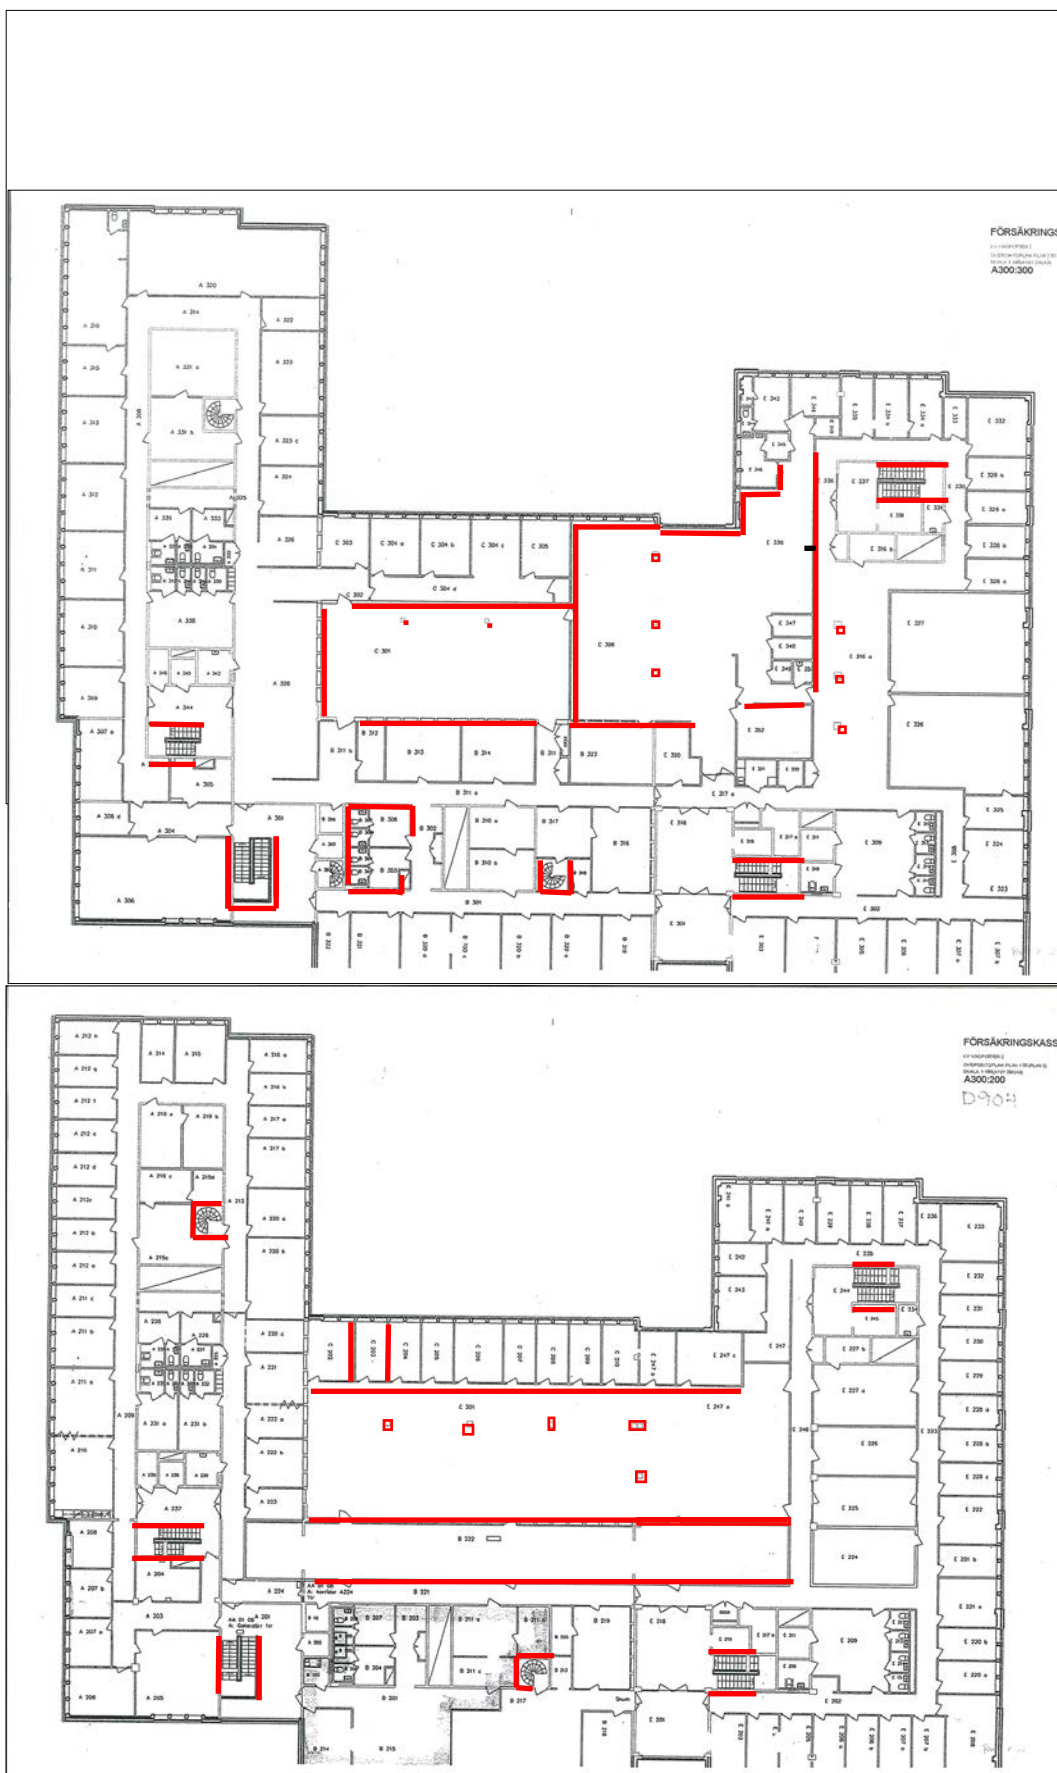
Den övre ritningen över kvarteret Vägporten 300:300 plan 2 tr, plan 3.
